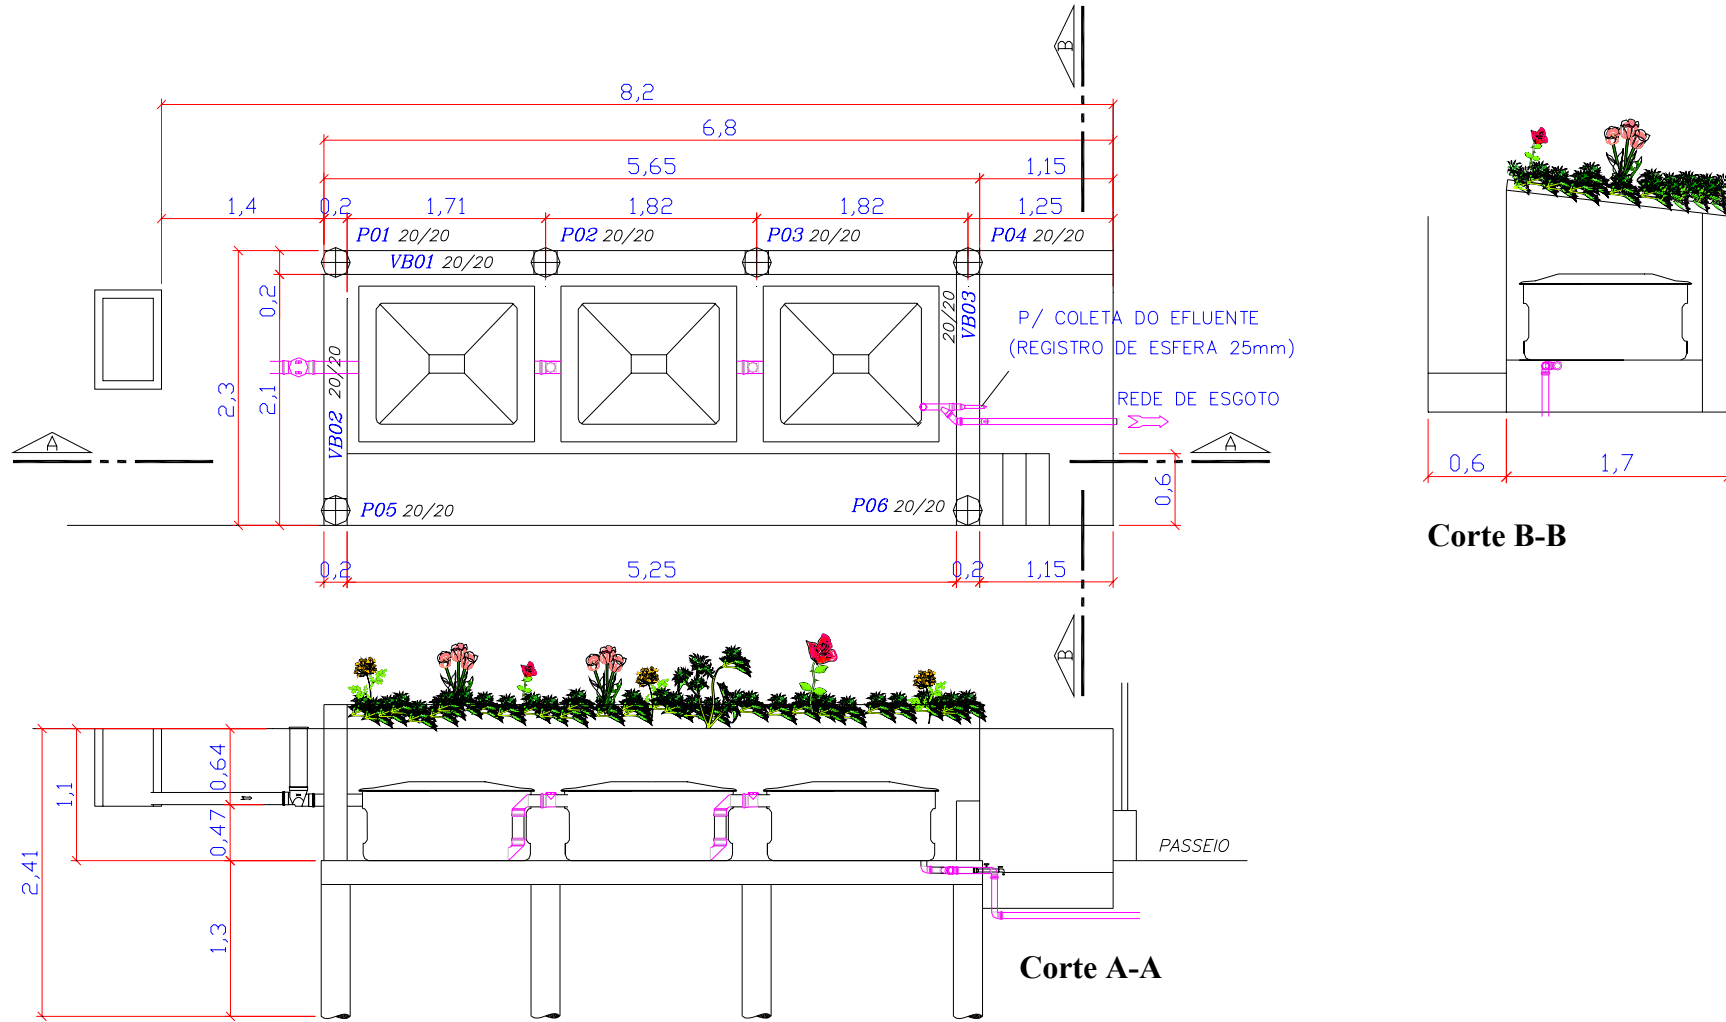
Projeto executivo da estrutura do telhado verde e proteção estrutural do biodigestor. Medidas em metros.
